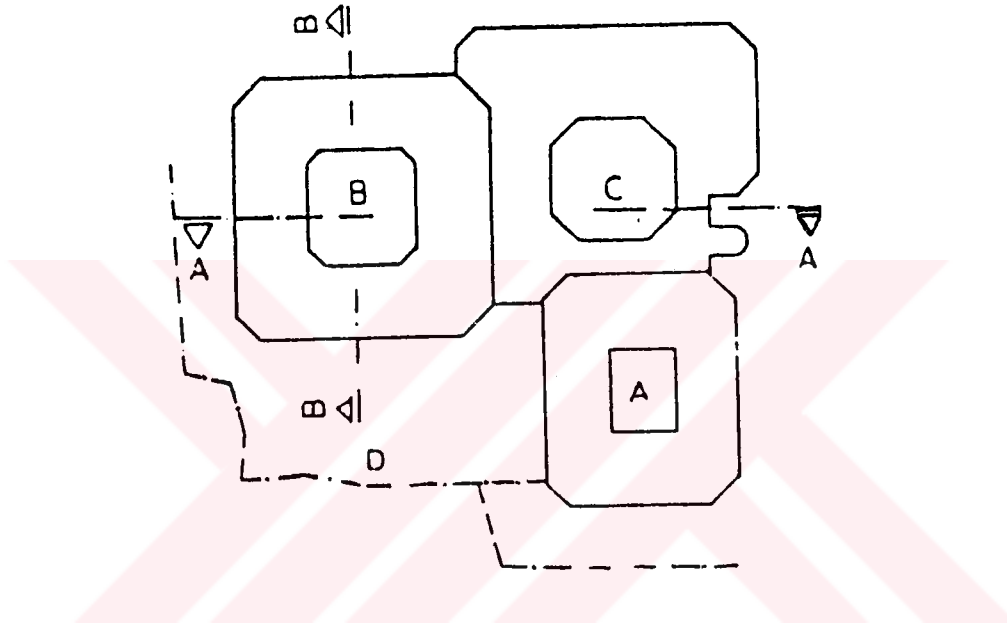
Barbaros Turizm ve Ticaret Merkezi Büro Katları Planı
